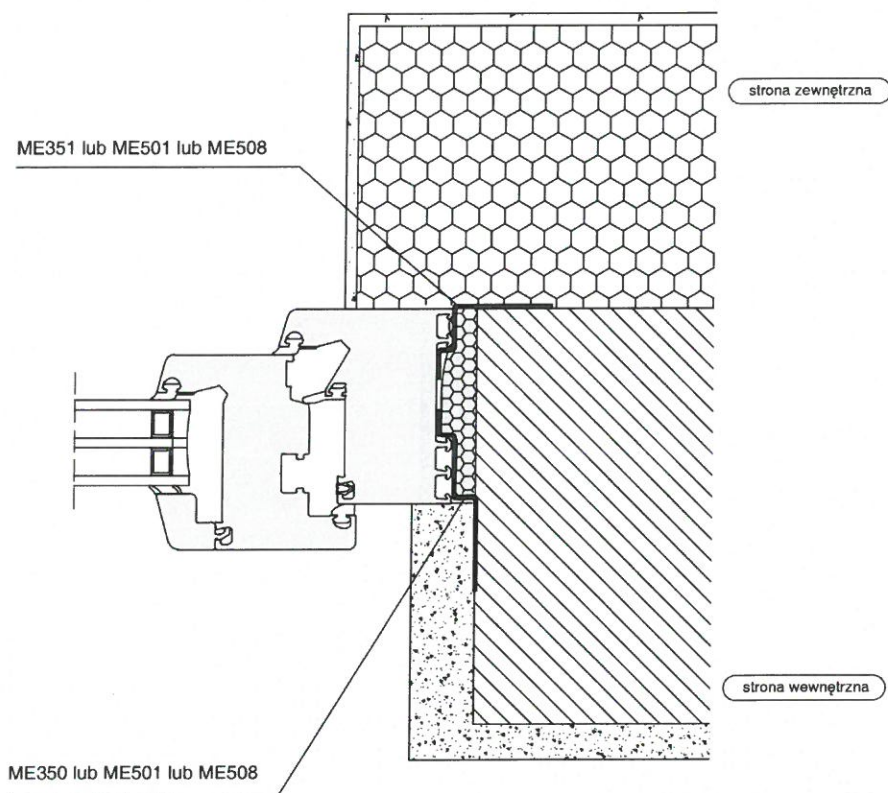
Przykład stosowania taśm uszczelniających i masy uszczelniającej illbruck przy montażu okna z drewna
